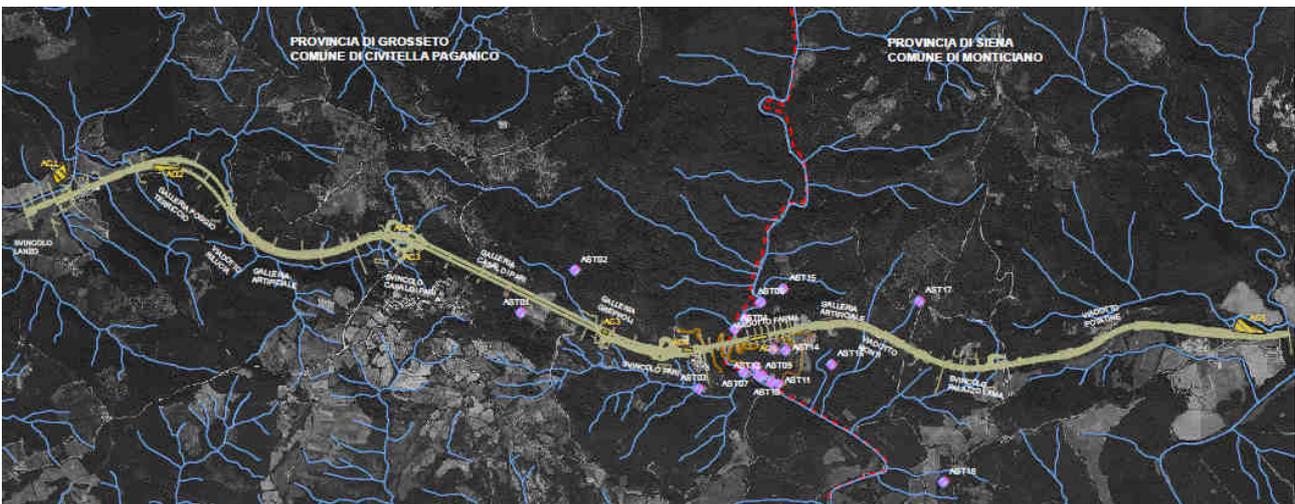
Planimetria generale – acque sotterranee / Sorgenti
